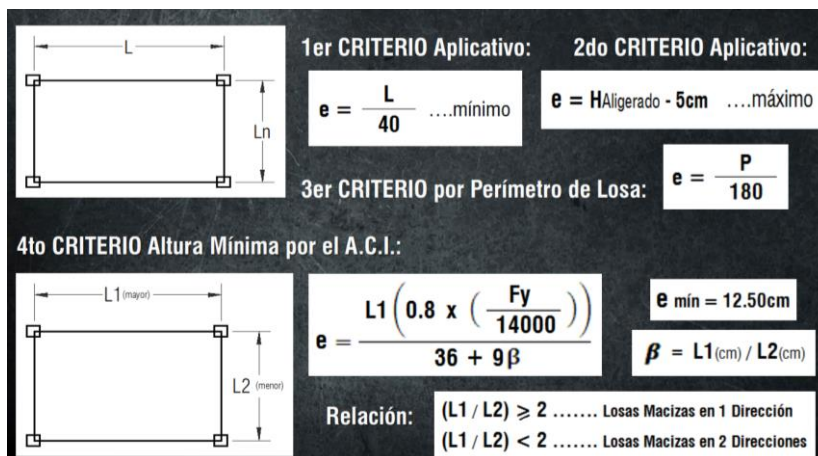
Predimensionamiento de losas aligeradas en una dirección.
